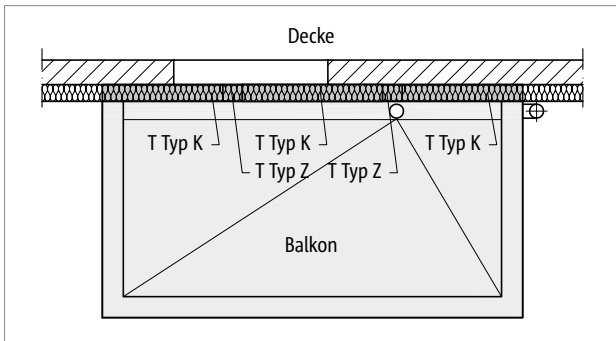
Schöck Isokorb® XT Typ Z, K: Aussparung für Entwässerung mit Schöck Isokorb® XT Typ Z
